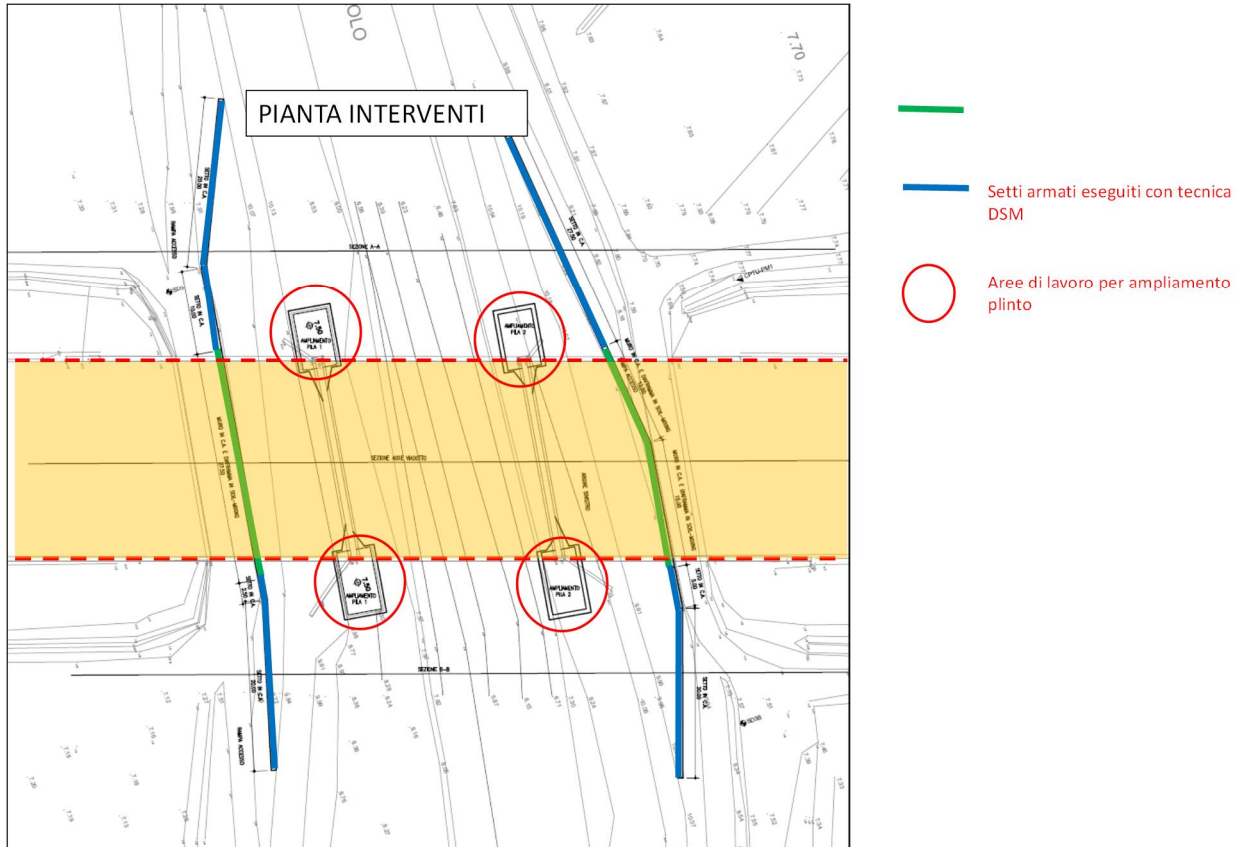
Ponte Canale Bagnarolo – Pianta interventi
